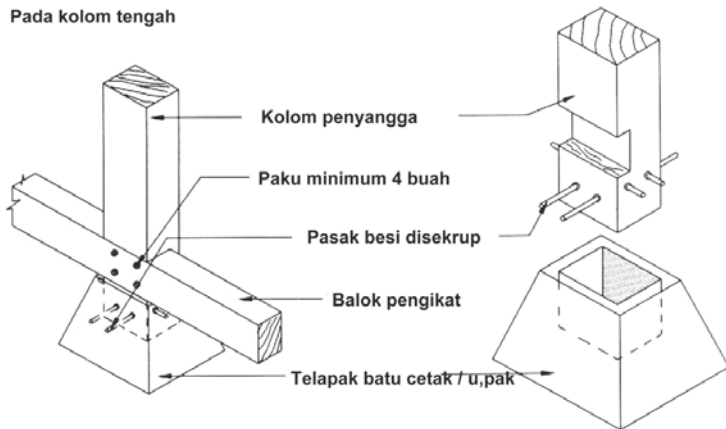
Hubungan pondasi tiang dengan balok penguat horizontal
